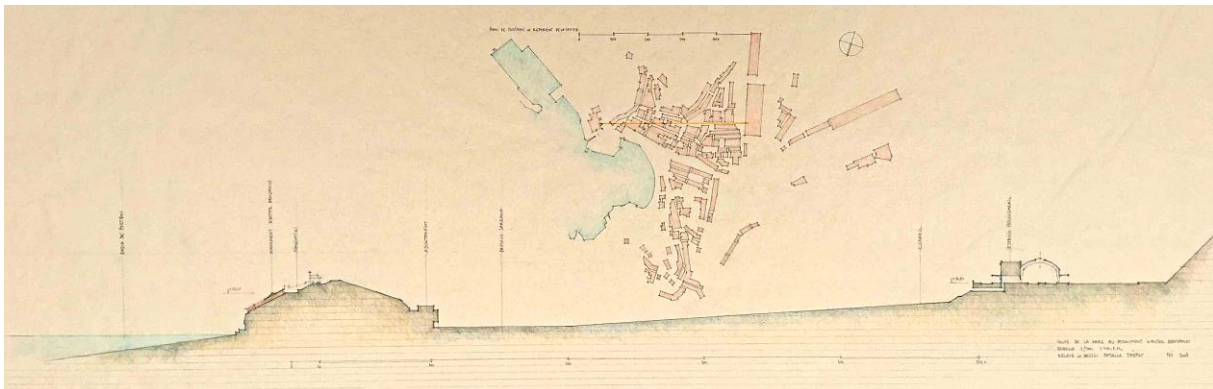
Coupe sur le site du cimetière et la gare + plan de la ville.
